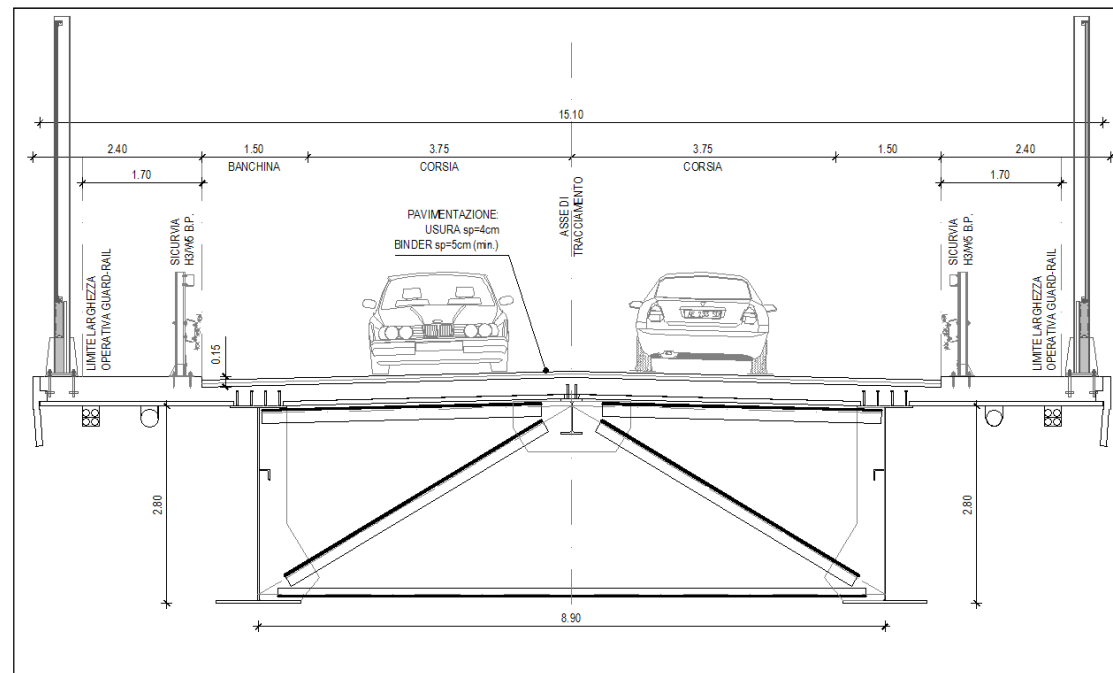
Esempio di sezione trasversale tipica dell'asta principale nel tratto su viadotto
